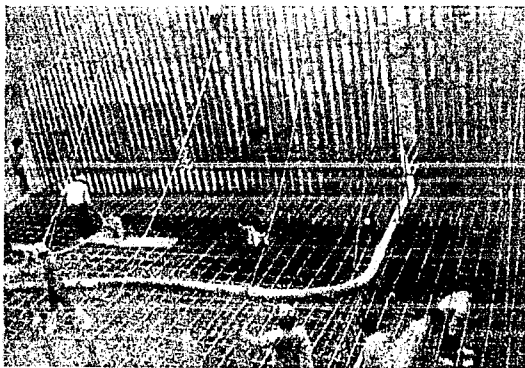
Construcción de la zapata del muro de retención en el Km. 11+792 al Km. 11+921.
